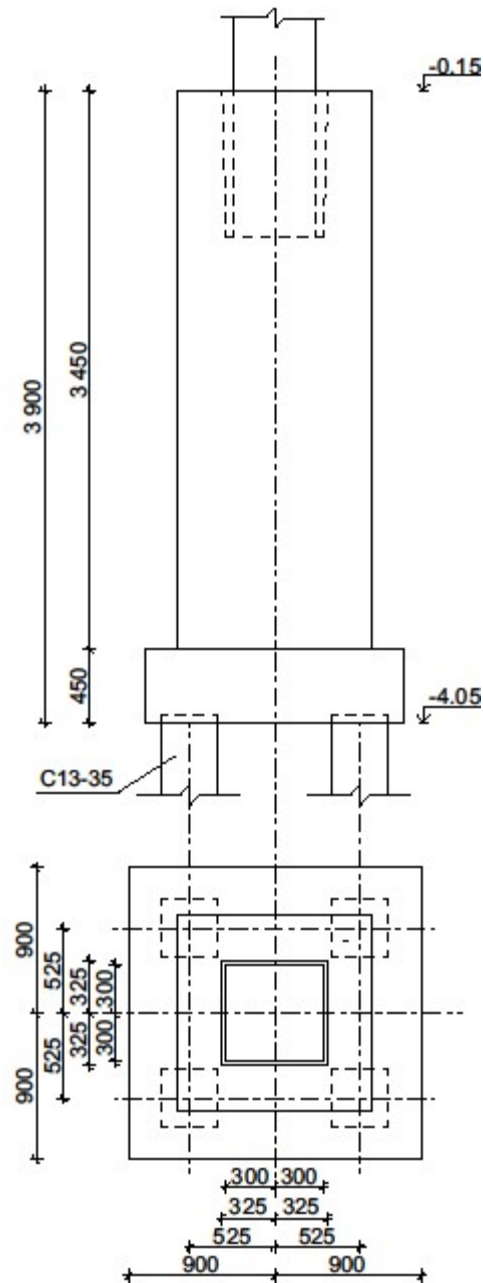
Конструктивне рішення ростверку пального фундаменту під збірну залізобетонну колону
